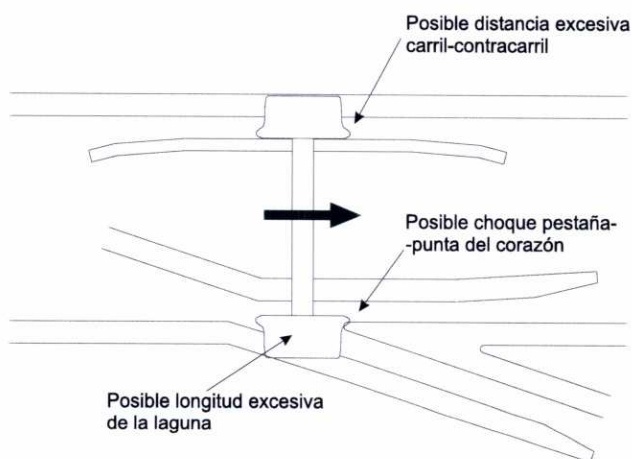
Planta de paso de eje montado por corazón de desvío. Fuente: [18].
